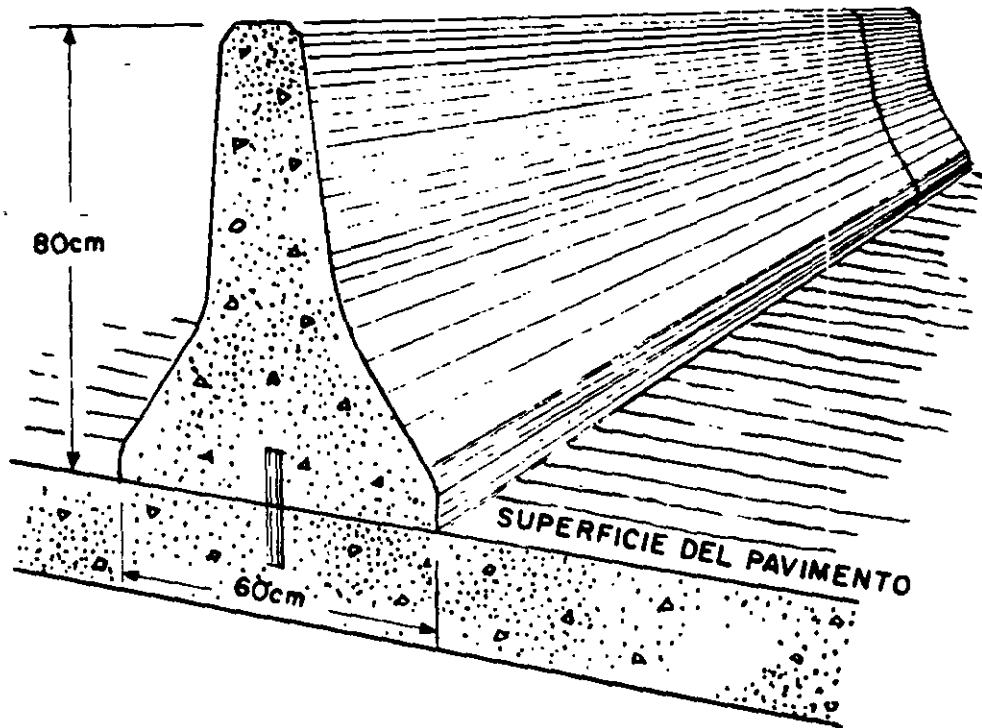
BARRERA USADA CON EXITO EN LOS ESTADOS DE NUEVA JERSEY Y CALIFORNIA EN ESTADOS UNIDOS DE AMERICA
